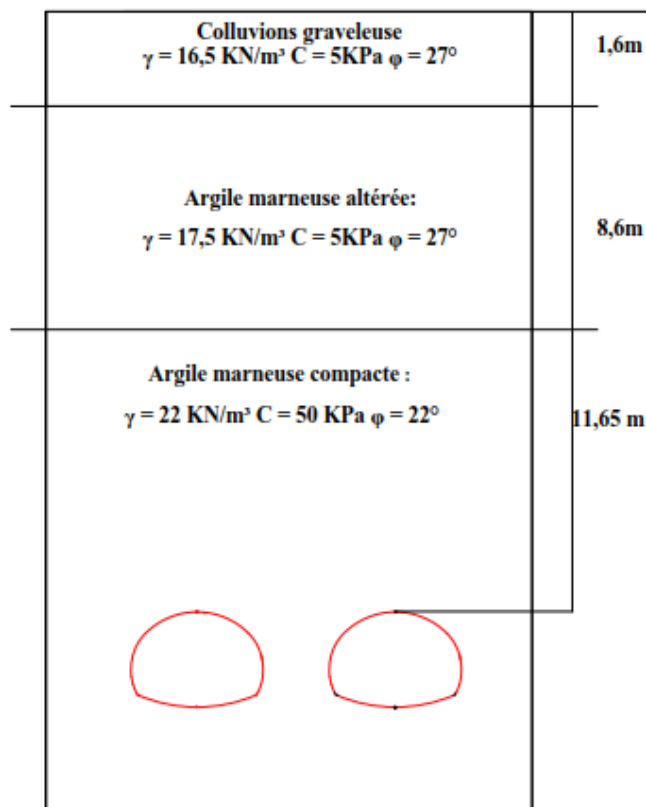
Coupe transversale de tunnel avec les différentes couches au dessus de tunnel.
